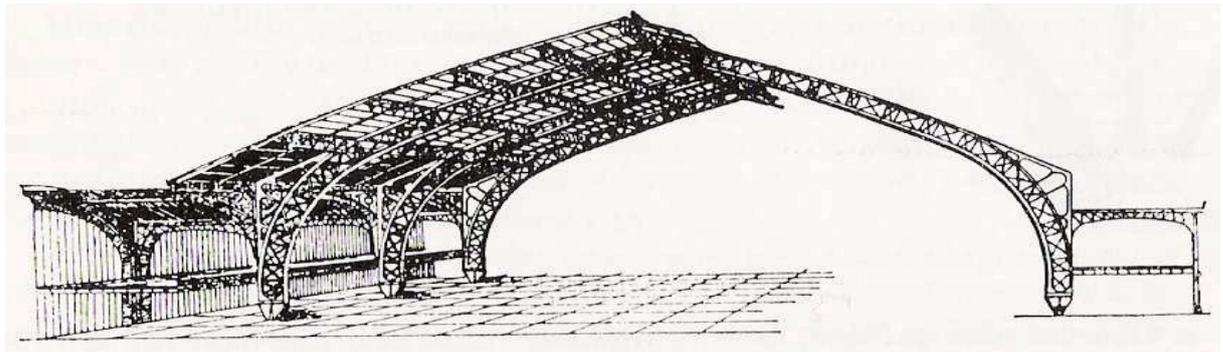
Konstruktionsschema der Maschinenhalle [1]
